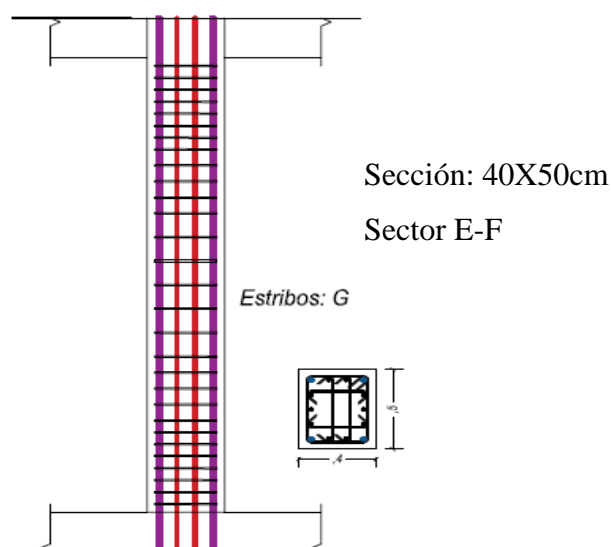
Detalle de Columna en Base Fija (E-F)
